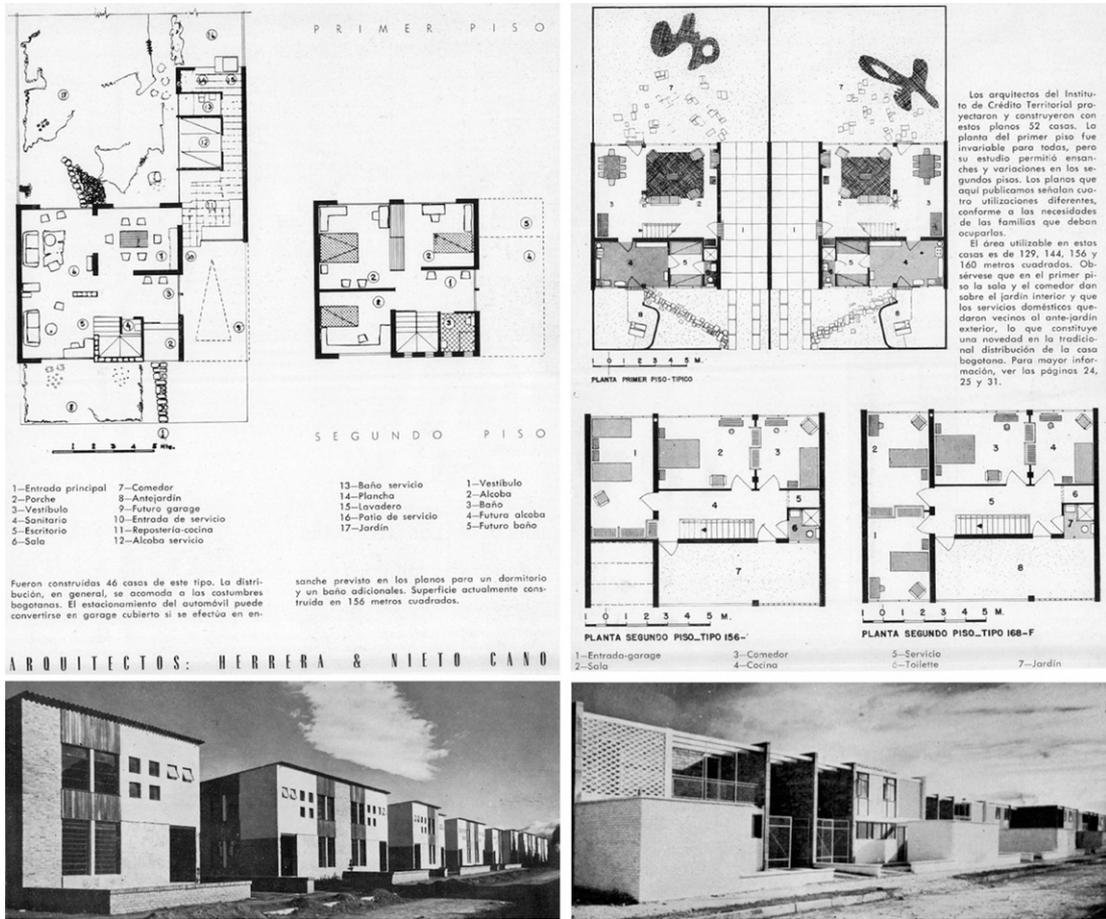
Casas tipo HNC e ICT Los Alcázares. Revista PROA, (octubre, 1949) 28, s.p.
